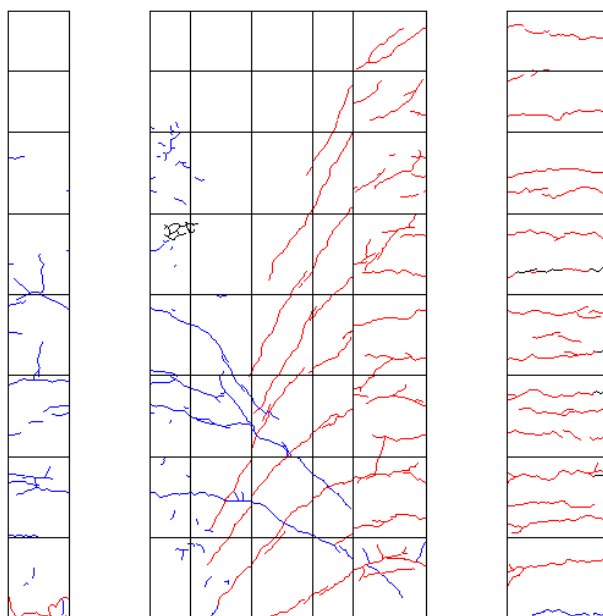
R=1/67②ひび割れ図
